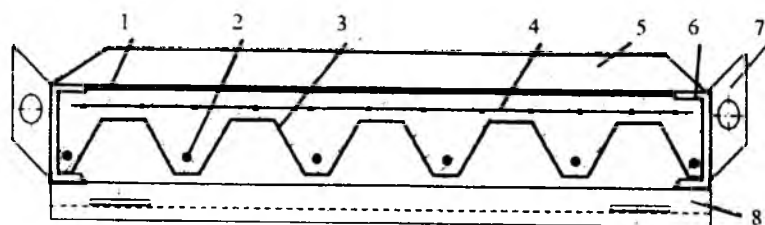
Поперечный разрез бетонозаполненной подвижной рамы виброплощадки
